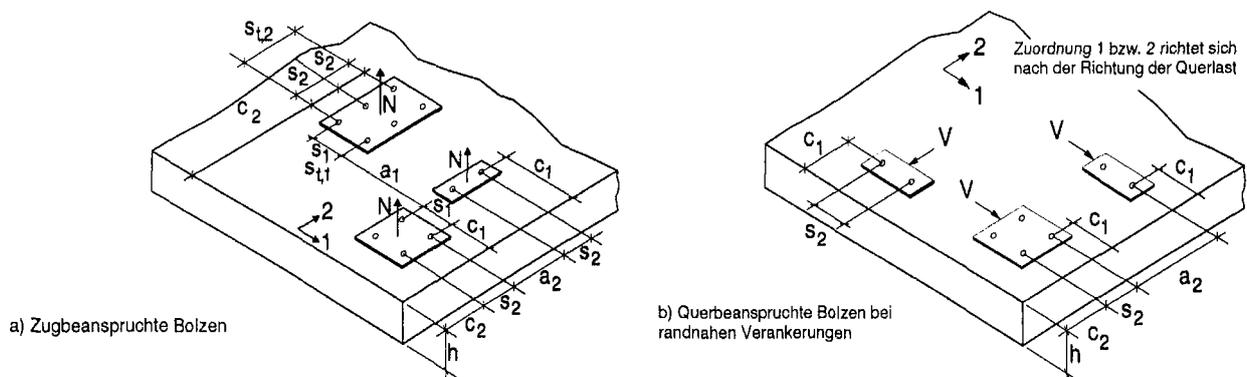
Betonbauteil, Bolzenachs- und Randabstände
